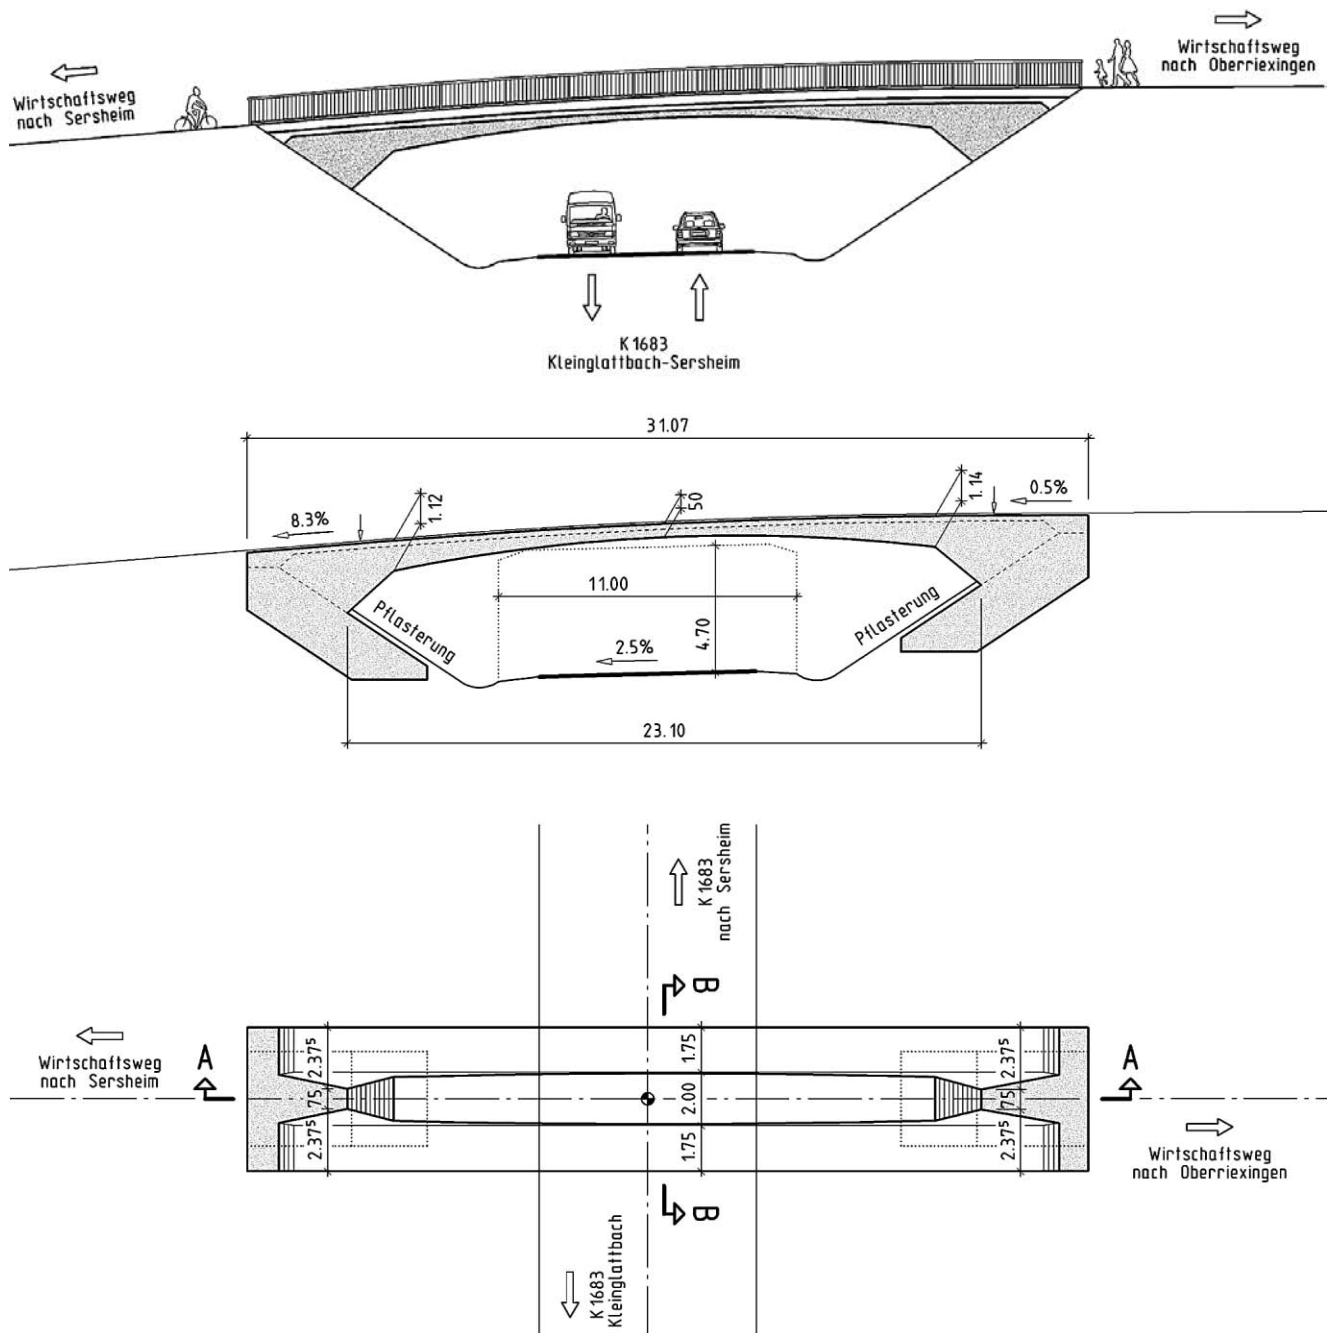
Bauwerk 3, Sersheim: Längsansicht, Längsschnitt A-A und Grundriß
